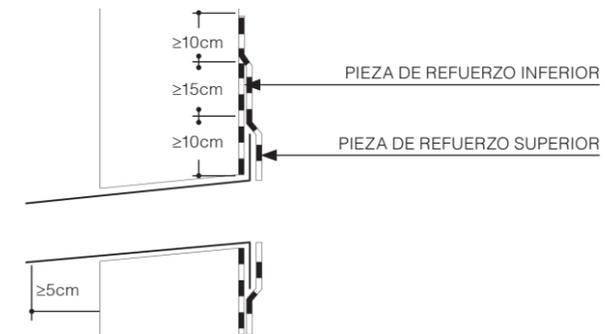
Detalles de encuentro de la impermeabilización con desagüe de seguridad
